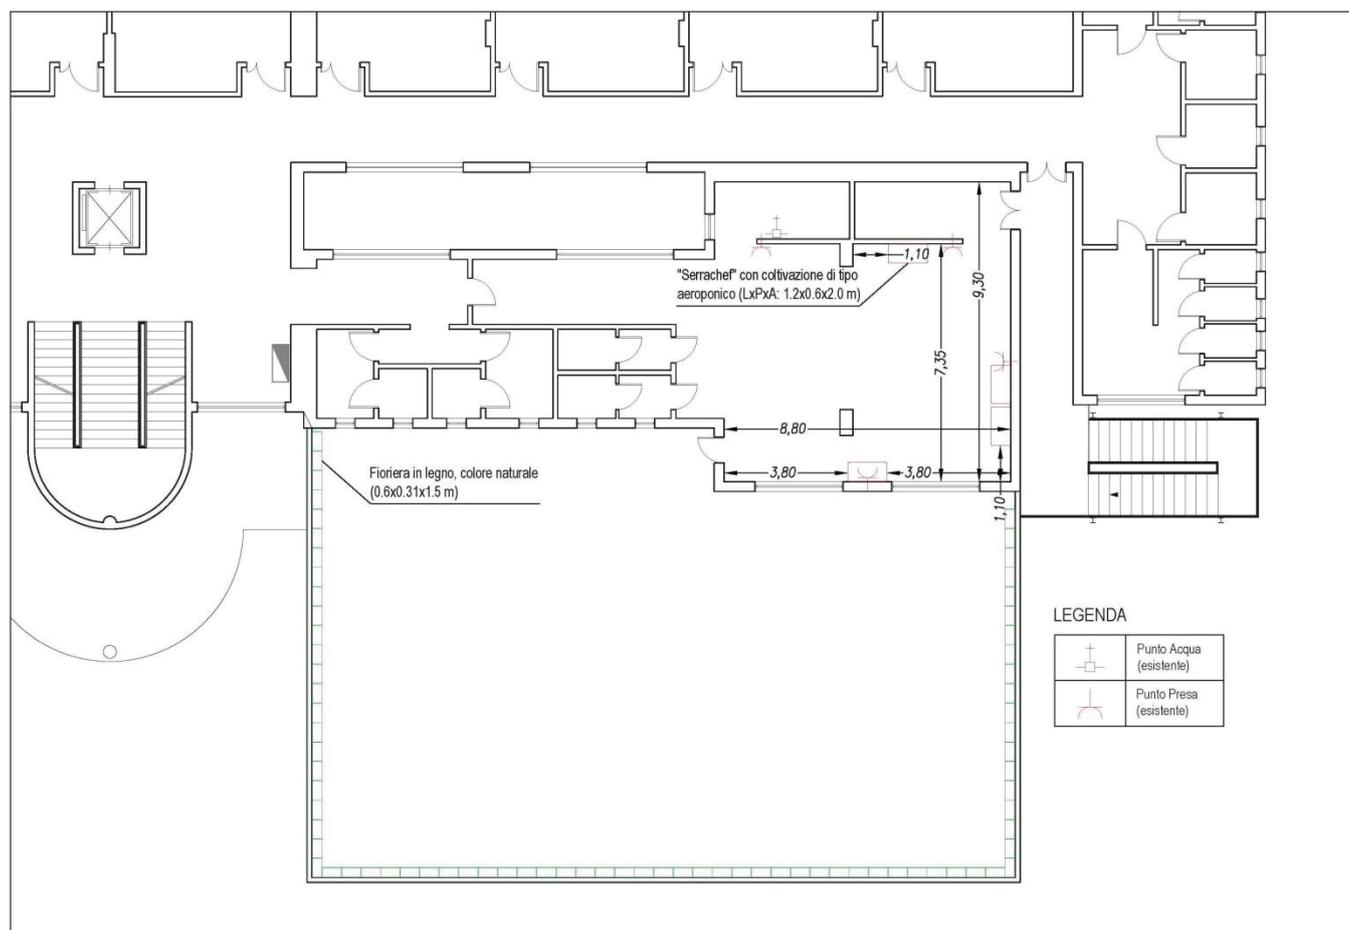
Pianta primo piano del Fabbricato B - Stato di progetto
